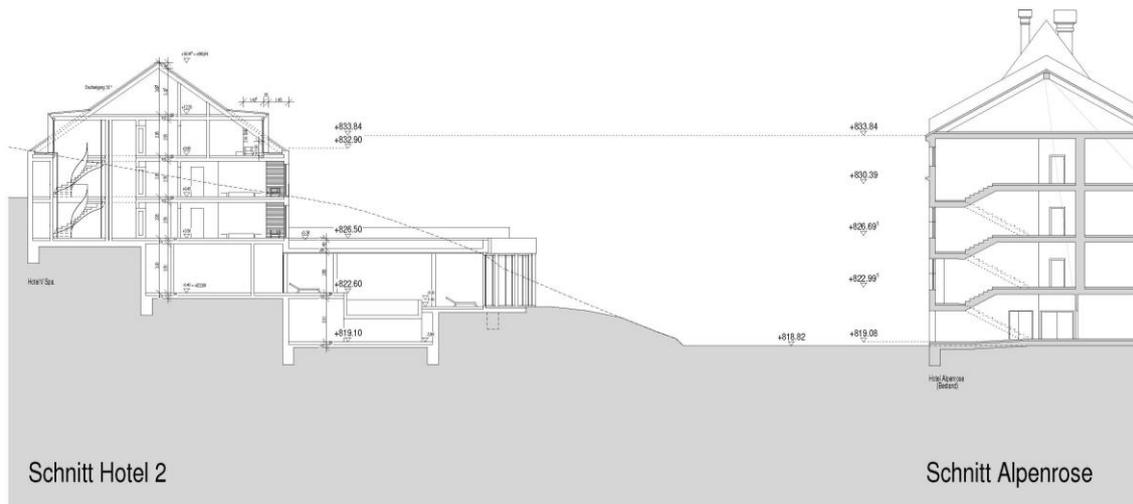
Querschnitt Haus 1 mit Spabereich und bestehendem Hotel Alpenrose - Traufhöhen
